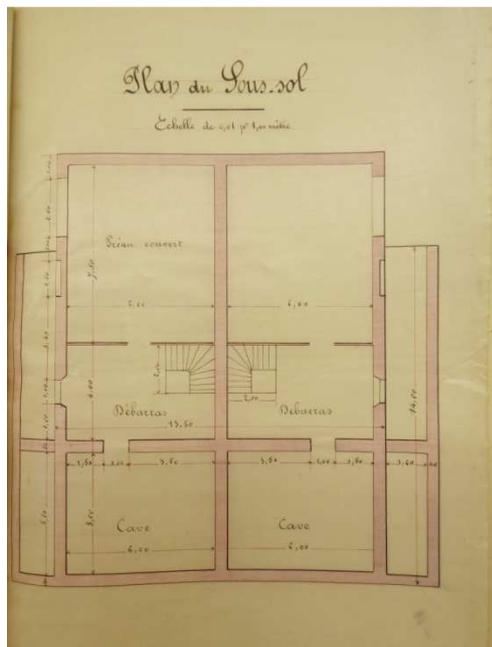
Projet de construction d'une maison d'école avec mairie, plan du sous-sol, Angeli (conducteur des Ponts et Chaussées).
